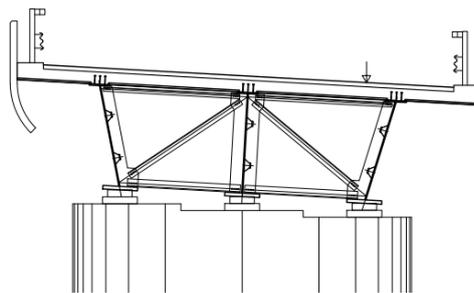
Sezione Strutturale Tipo del Viadotto
